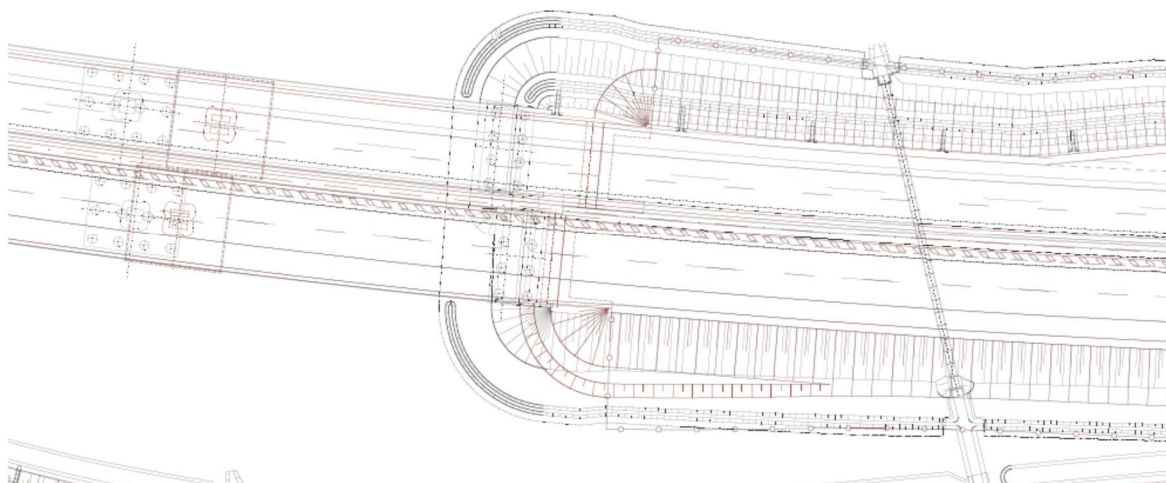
Tracciato autostradale – modifica Spalla B Ponte sul Fiume Taro
